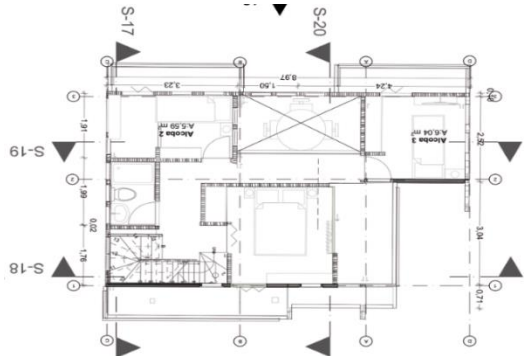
Planta vivienda 1 primer nivel. Autoría propia.
